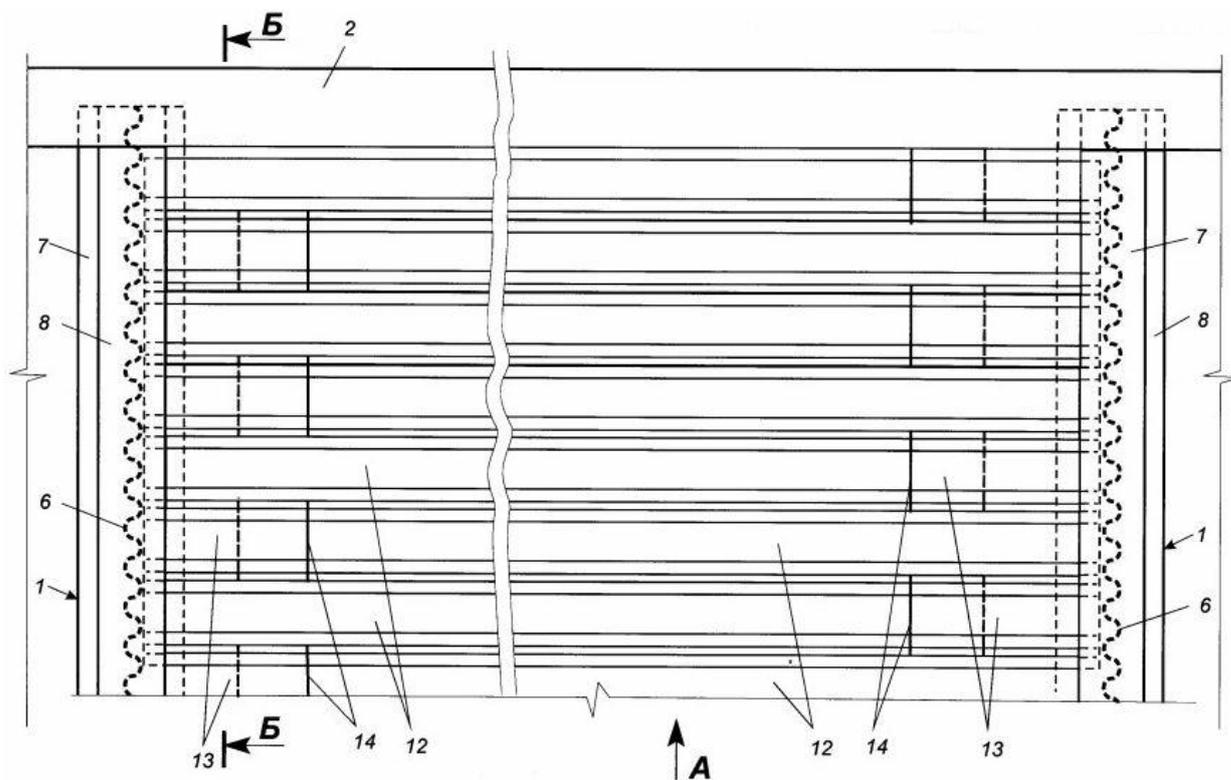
Фрагмент большепролетного перекрытия с двумя двутавровыми балками и набором опалубочных элементов, вид сверху
